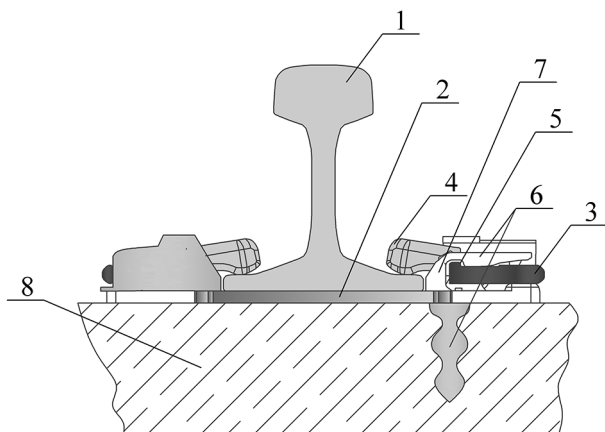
Рельсовое промежуточное скрепление системы Pandrol Fastclip FE RR: 1 — рельс; 2 — подрельсовая прокладка; 3 — упругая клемма; 4 — прижимной изолятор; 5 — фиксатор рабочего положения; 6 — анкер; 7 — боковой опорный изолятор; 8 — шпала
